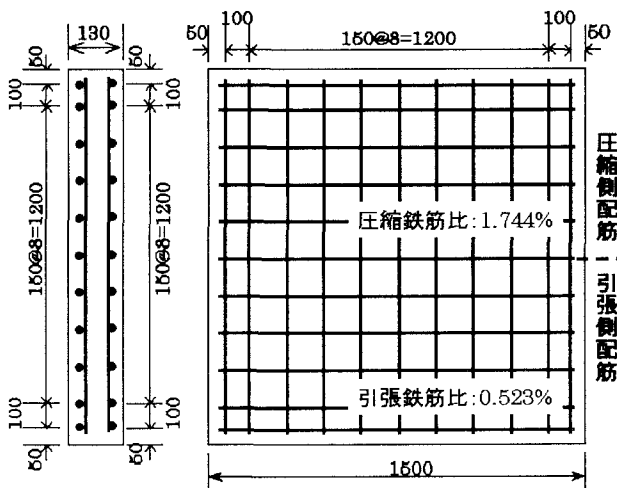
供試体の配筋図および断面図 (20・40-As-1,2)
